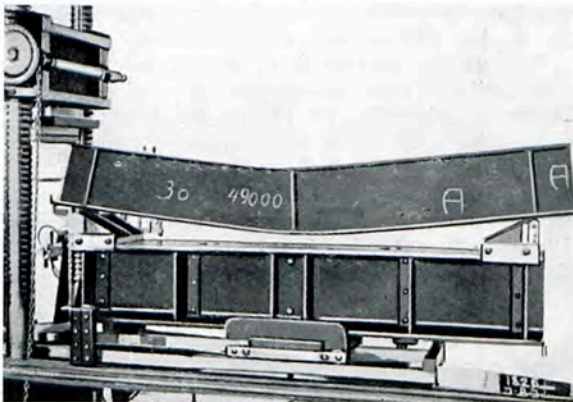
Essai d'une poutrelle munie de 3 raidisseurs.
